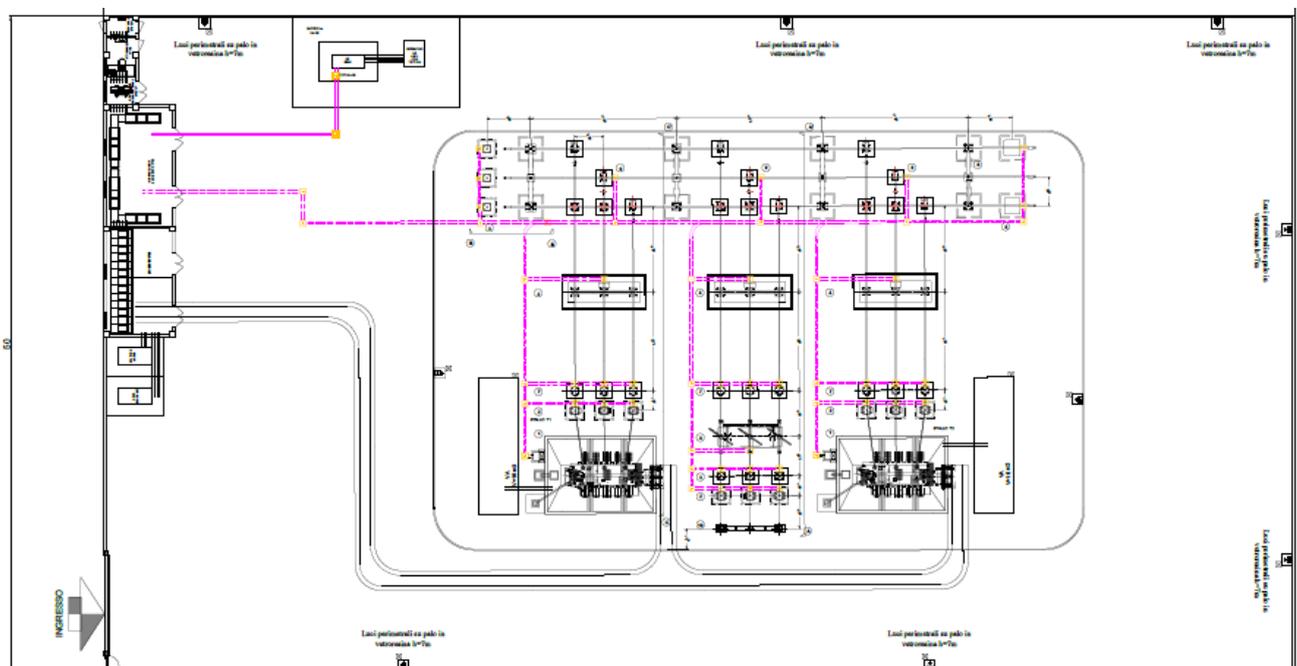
Planimetria Stazione Elettrica Utente AT/MT
